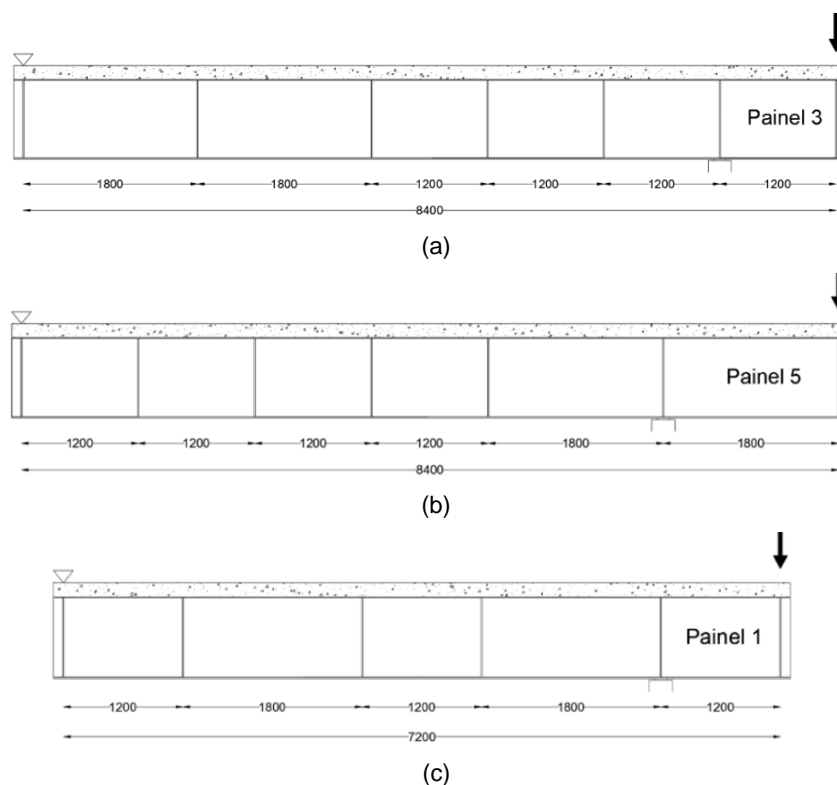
Esquema do ensaio MI 4 para: (a) Painel 3 da viga F1; (b) Painel 5 da viga F1; (c) Painel 1 da viga F2
